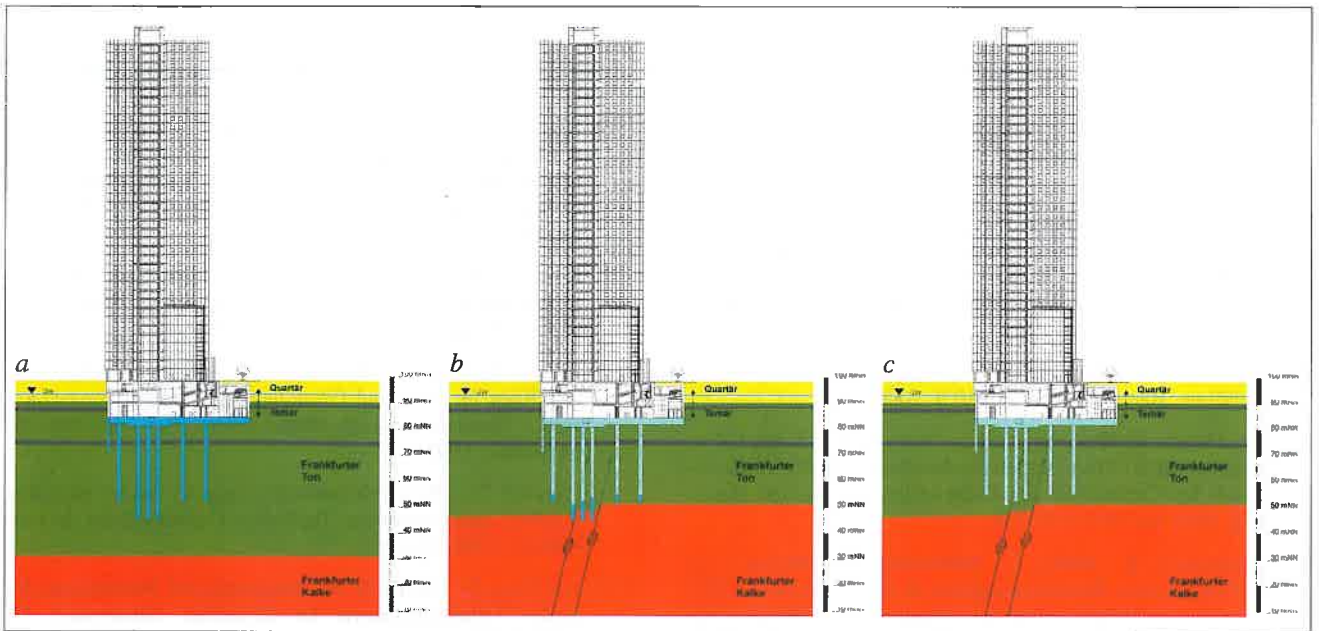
a – c: Hochhaus inkl. Gründung und schematischem Baugrundaufbau
